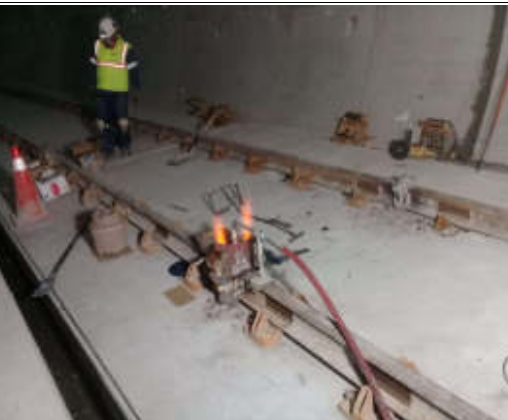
17-12-19. Soldaduras en el tramo de reposición de vía Solanda - Cardenal de la Torre.
